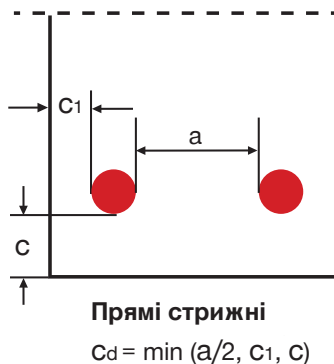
Коефіцієнт на основі бетонного покриття та кроку арматури
